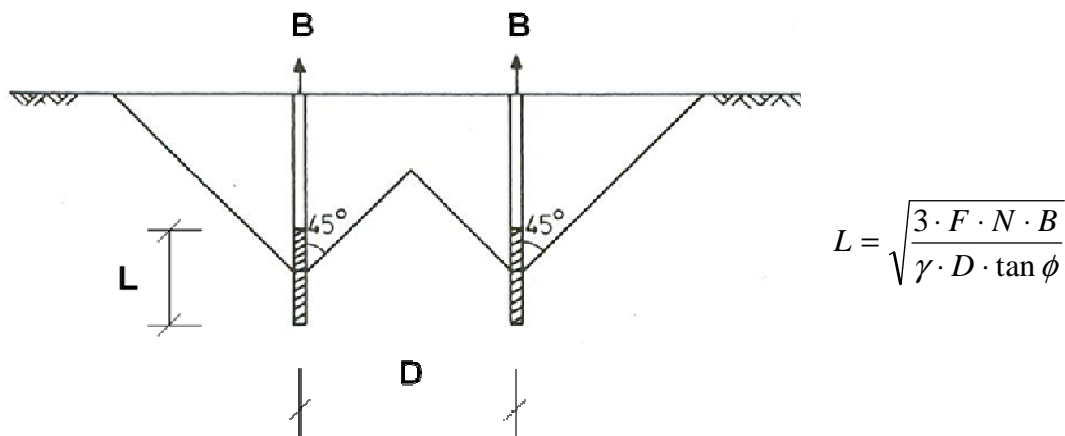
31 Dimensjonering av stagforankret mur.
